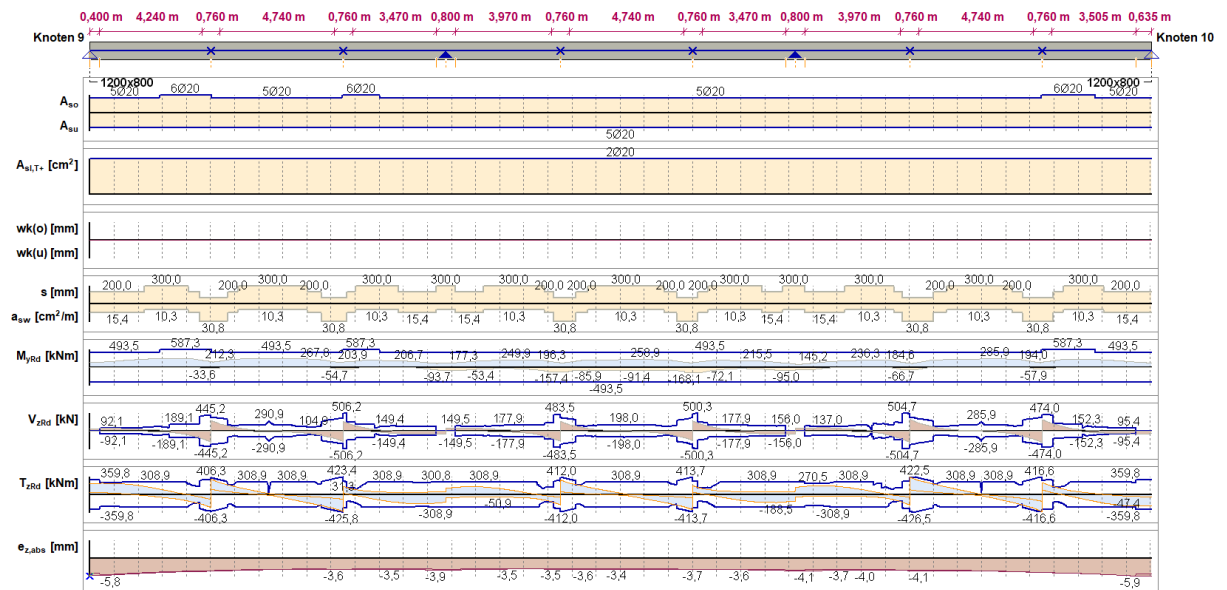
Berechnete Balkenbewehrung, Achse A, vertikale Ebene
